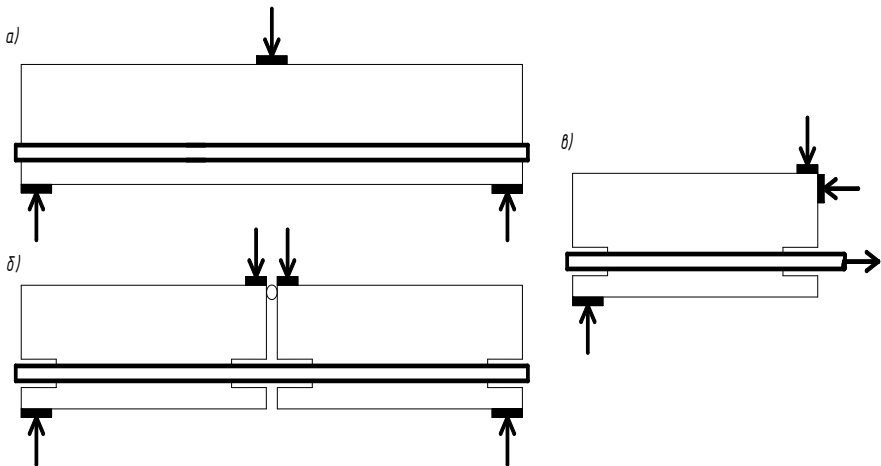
Схеми експериментальних досліджень зчеплення арматури з бетоном при моделюванні реального стану бетону в згинально-зміщуваних виступах (між ребрами арматури)
